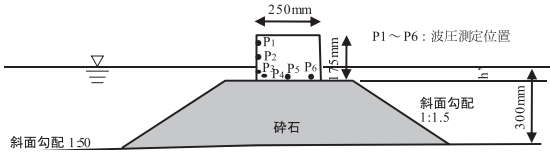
実験 c) 捨石傾斜堤上部工断面図 (谷本・小島, 1983)
